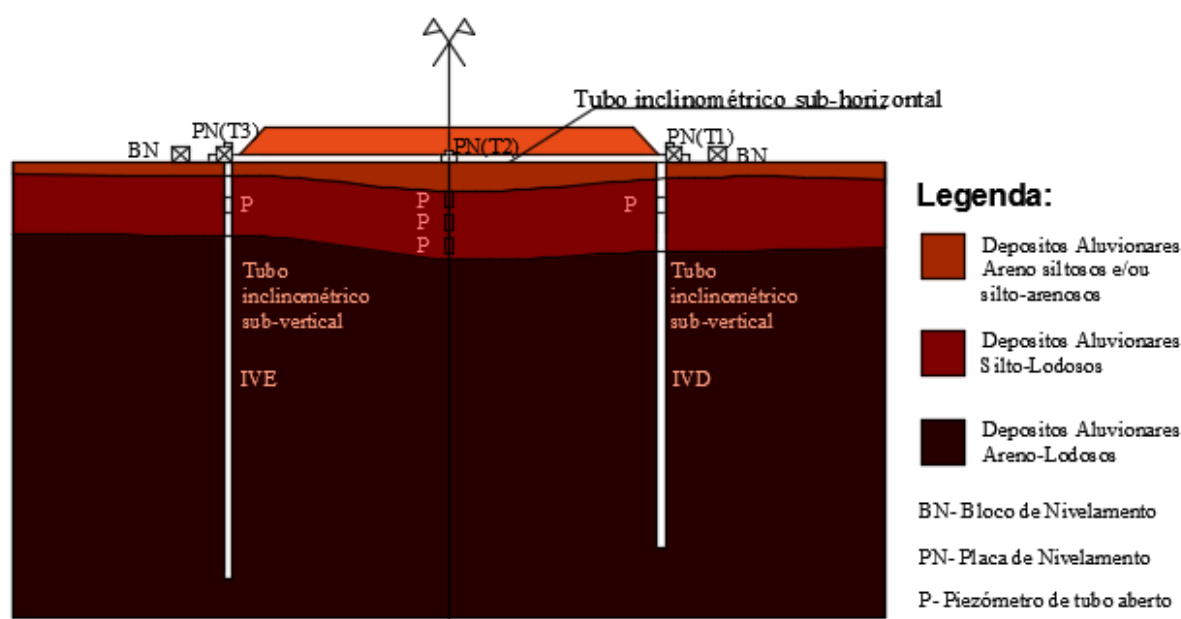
Perfil geotécnico da secção 9+425 Km, com indicação das sondagens e da instrumentação instalada.
